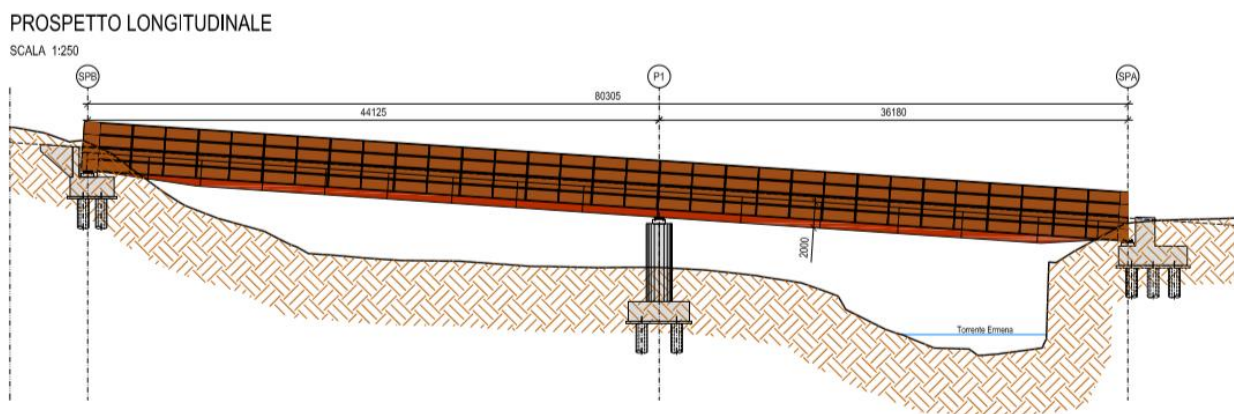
Ponte sul Torrente Ermena - Profilo longitudinale
